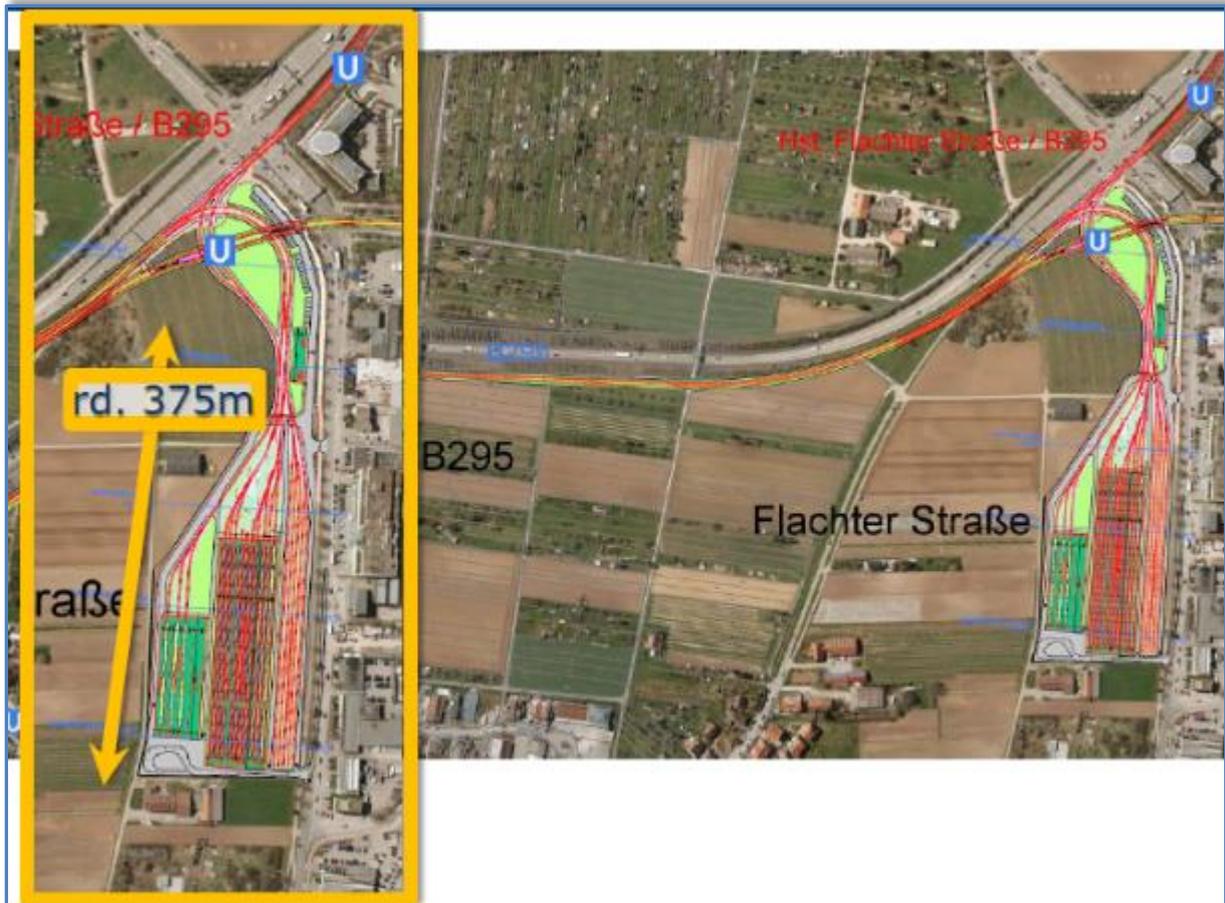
Lageplan des Standorts Weilimdorf – Flachter Straße
